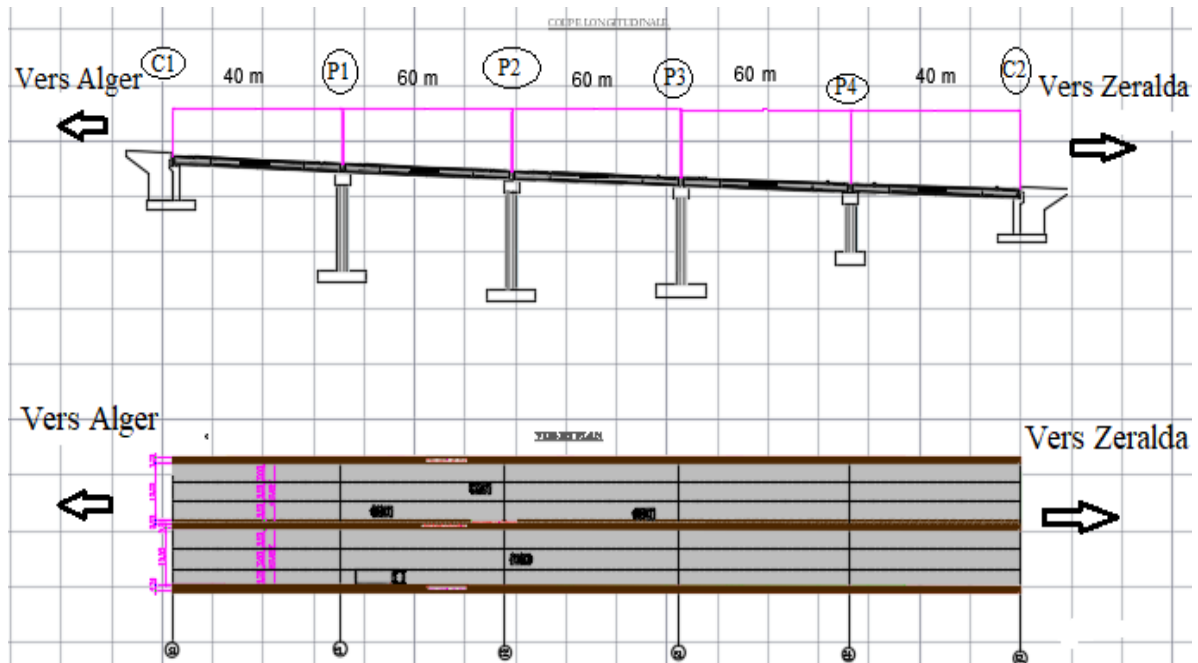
Coupe longitudinale et le tracé en plan de la 1<sup>ère</sup> variante
